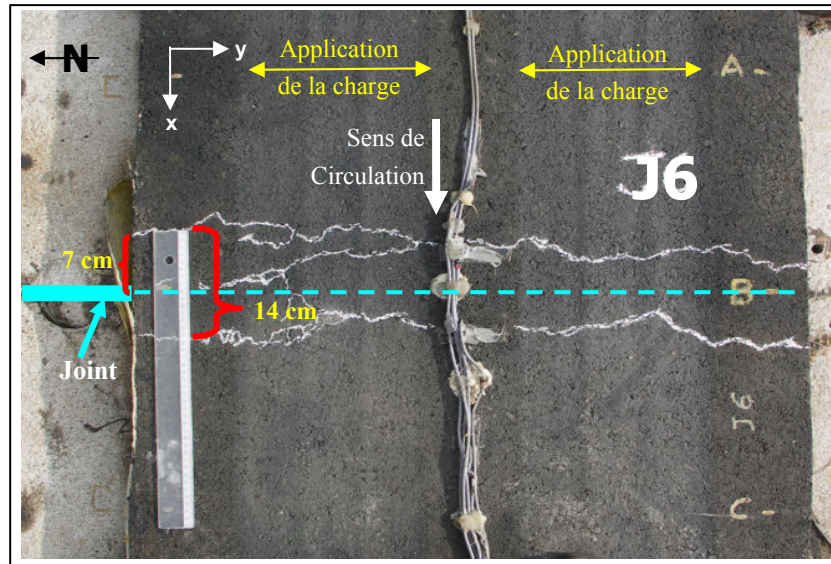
fissuration réfléchive double survenue sur le joint 6
